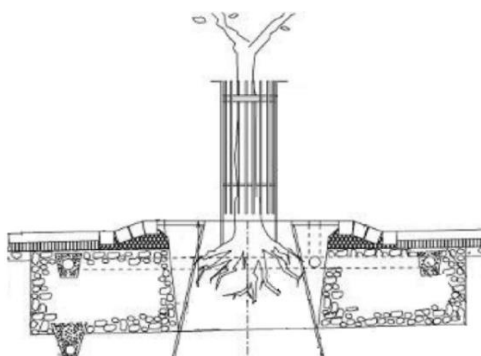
Solo esquelético adjacente ao poço de plantio (Bühler, 2008).
